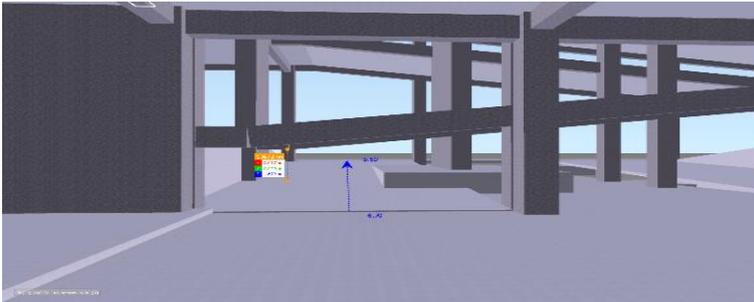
En el plano de arquitectura “AR. RPE GS.01
